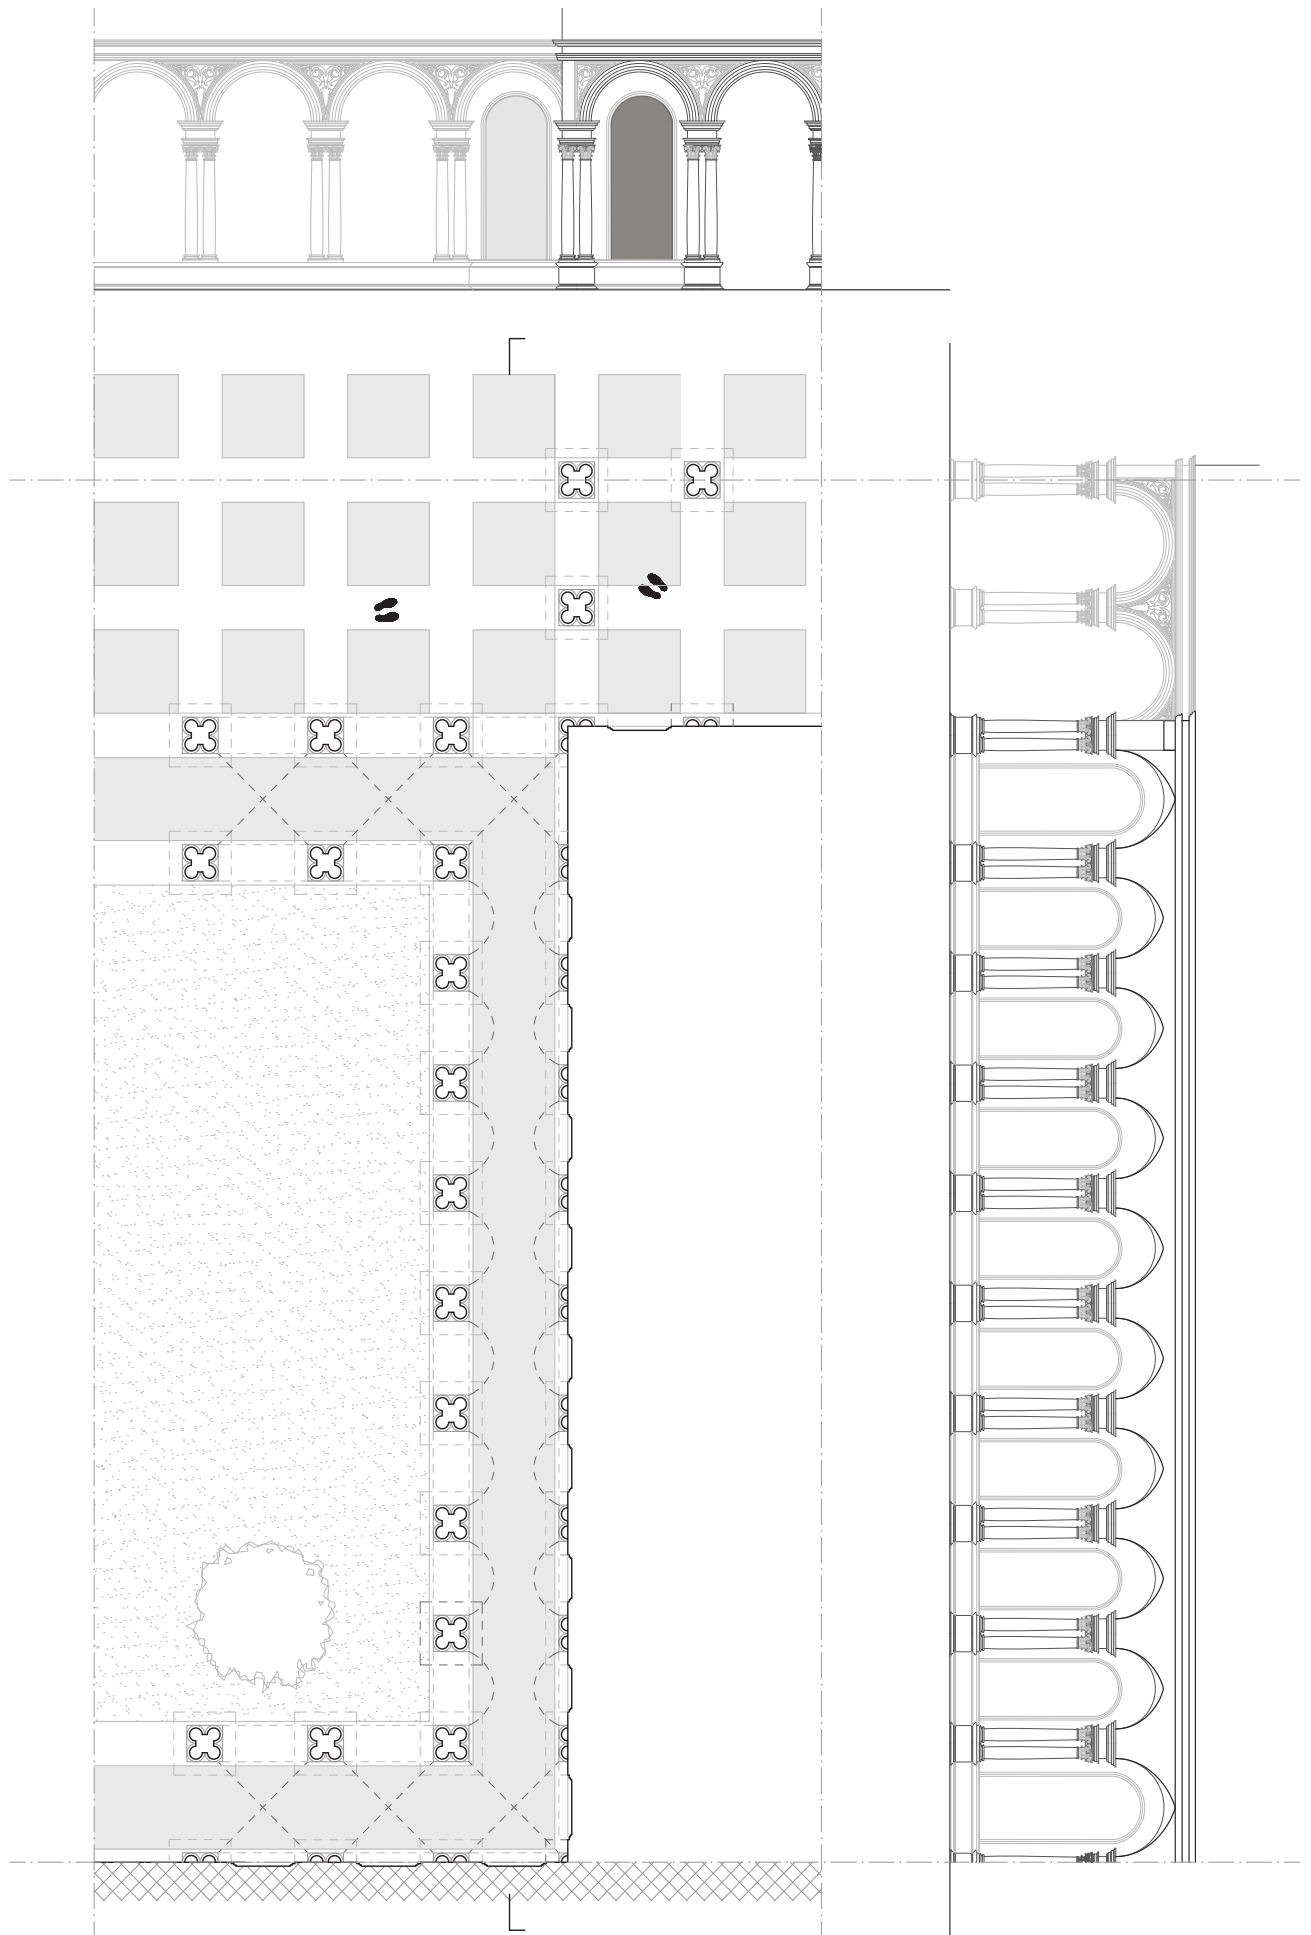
Planta, alzado y sección restituidas de la Anunciación de San Antonio.
